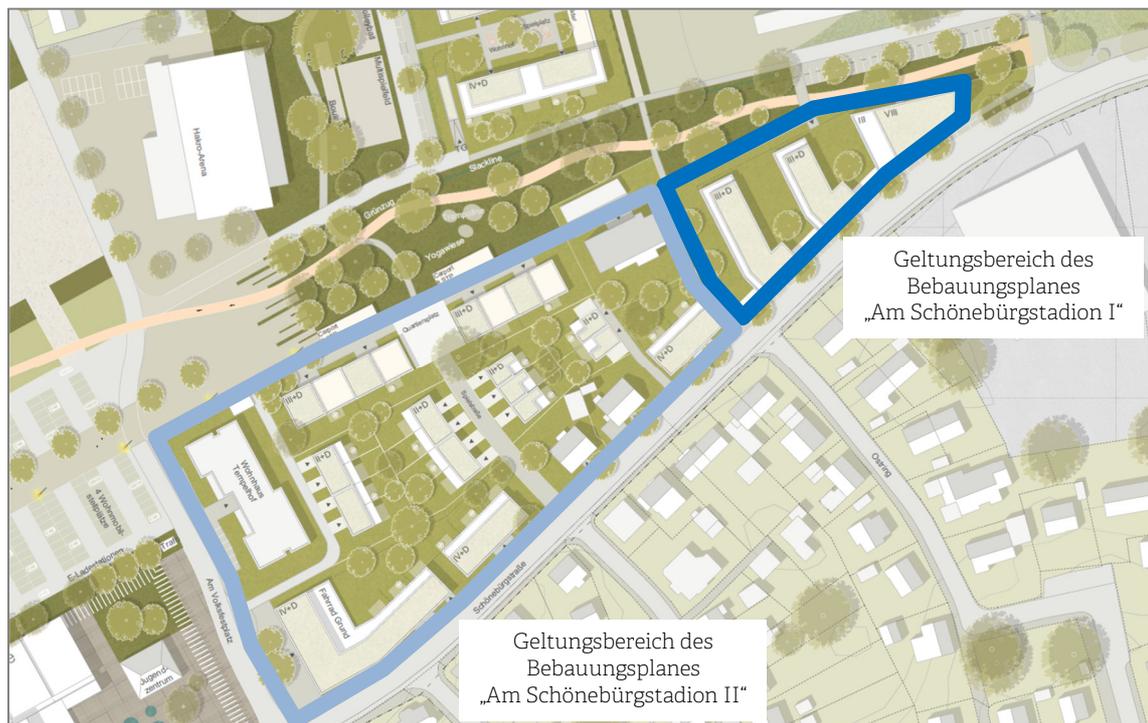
Masterplan „Östliche Innenstadt“, Ausschnitt Bebauungspläne „Am Schönebürgstadion I“ und „Am Schönebürgstadion II“, unmaßstäblich
